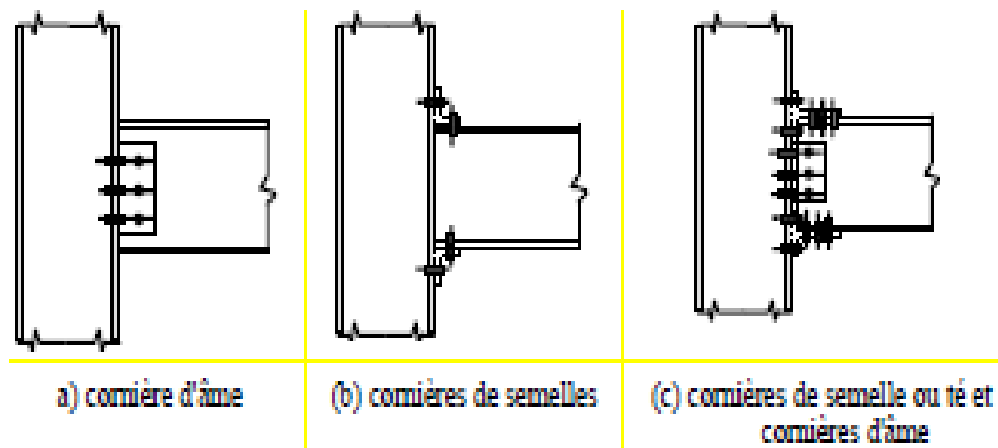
Assemblage poutre-poteau par cornières d'âme et/ou des semelles
